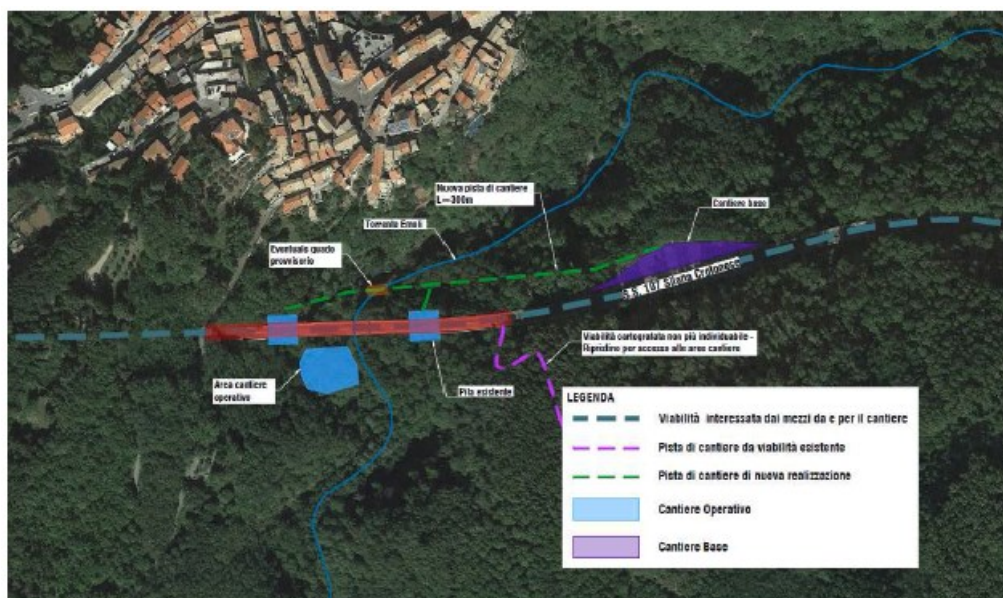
Planimetria aree di cantiere e piste di accesso Viadotto Emoli 2 (Fonte: Lista di Controllo).
